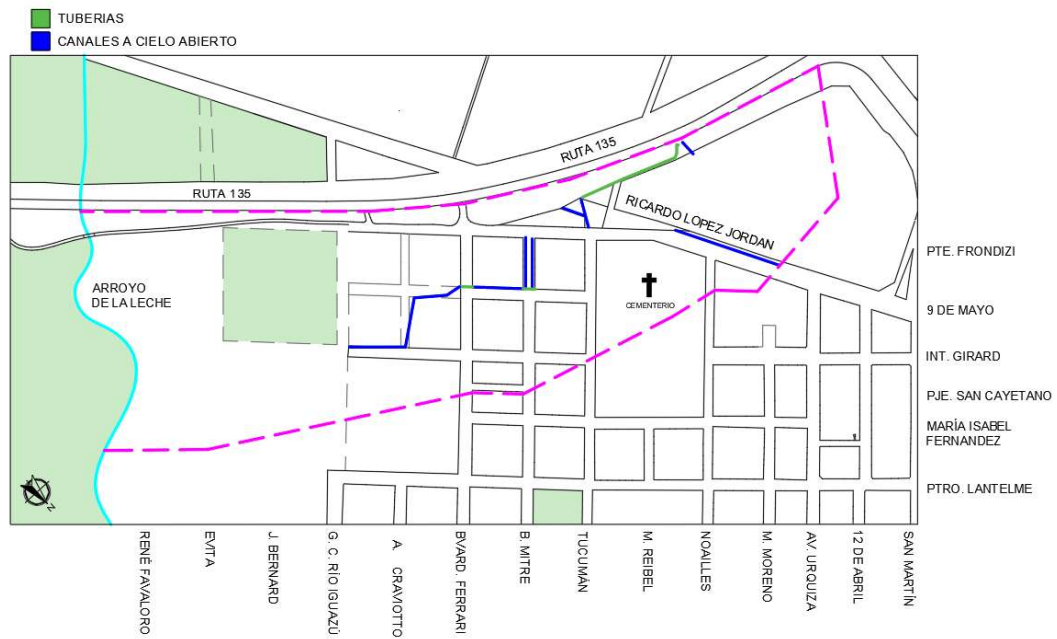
INFRAESTRUCTURA DE DRENAJE.
